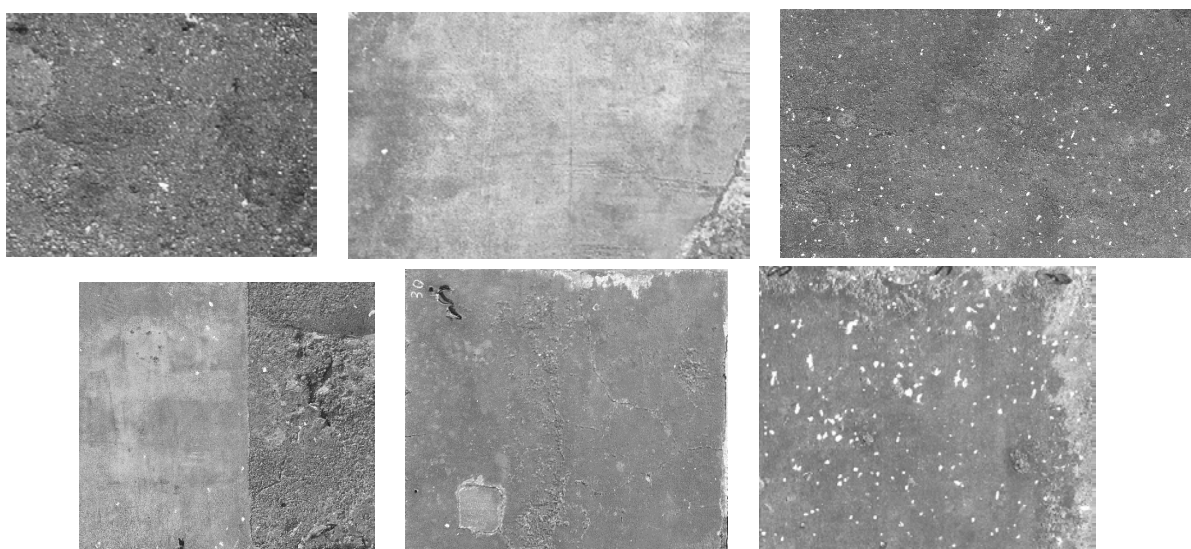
ひび割れ派無いが「ひび割れ有り」と誤って判読された画像
